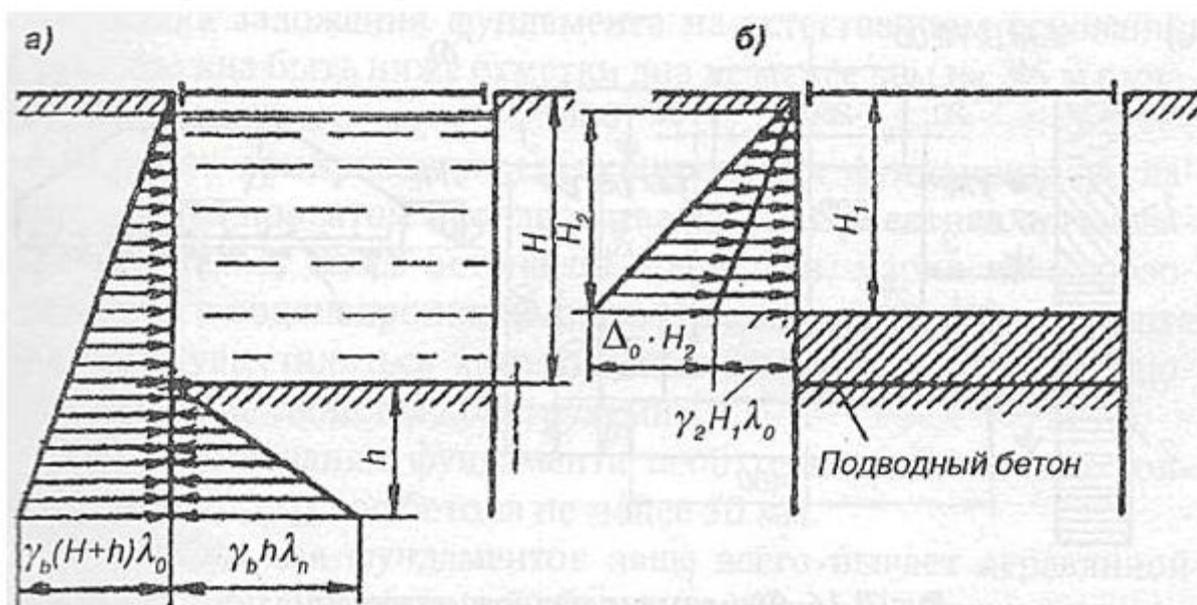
Расчетные схемы стенки в случае укладки тампонажного слоя бетона: а – до укладки подводного бетона; б – после откачки воды из ограждения
